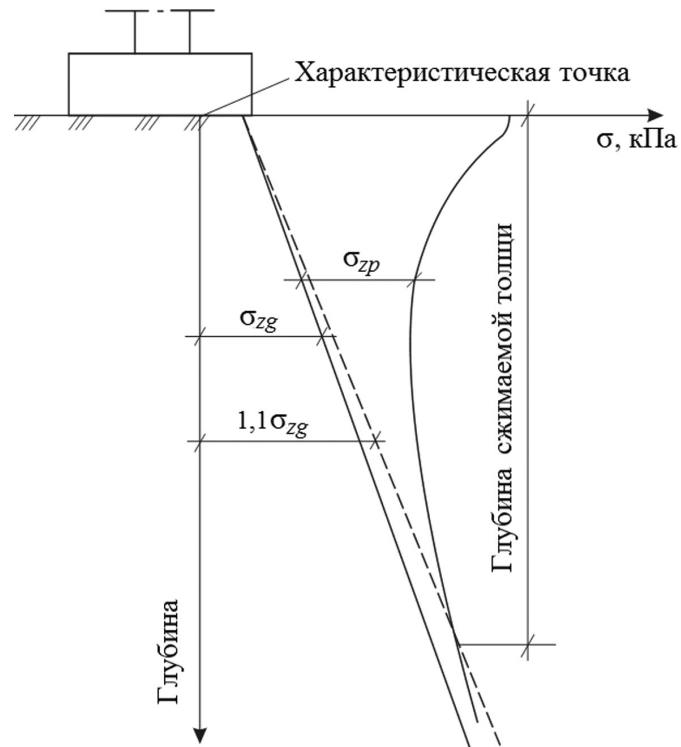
Расчетная схема оценки осадок фундамента мелкого заложения на песчаных грунтах по работе [9]. Обозначения: σ — полное напряжение; σ_{zg} — природное (бытовое) напряжение от собственного веса грунта; σ_{zp} — дополнительное напряжение от веса сооружения
